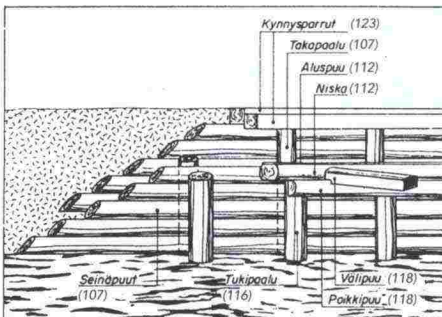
Sillan alusrakenteet ja sillapaikan rakenteet.
